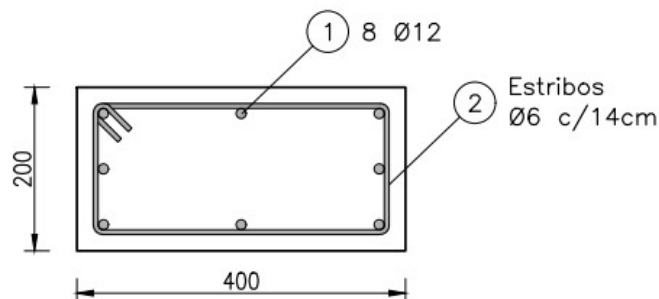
Armaduras columnas 20 cm x 40 cm
